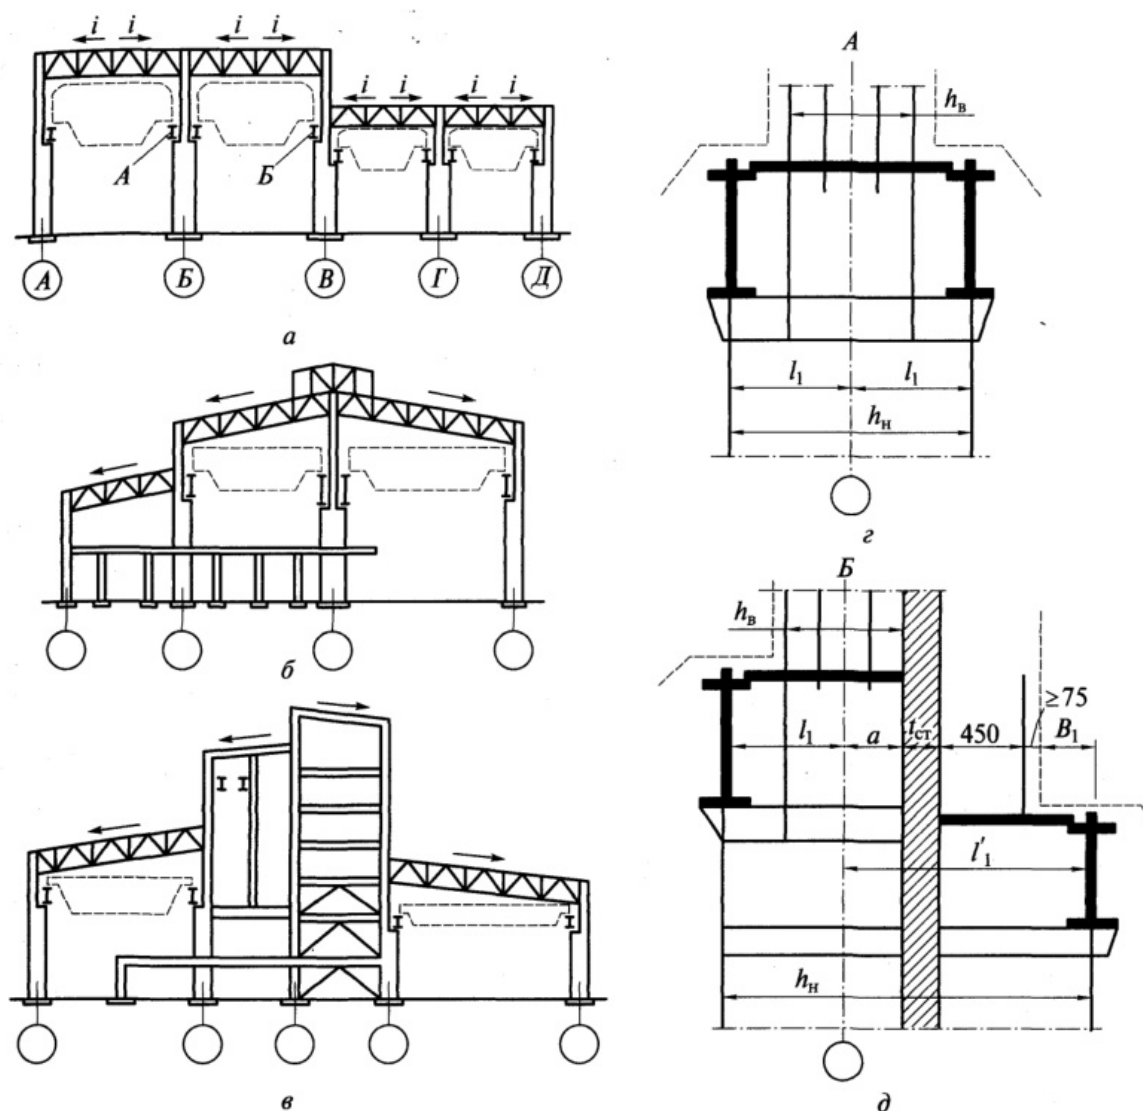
Примеры схем поперечных рам многопролетных зданий:
